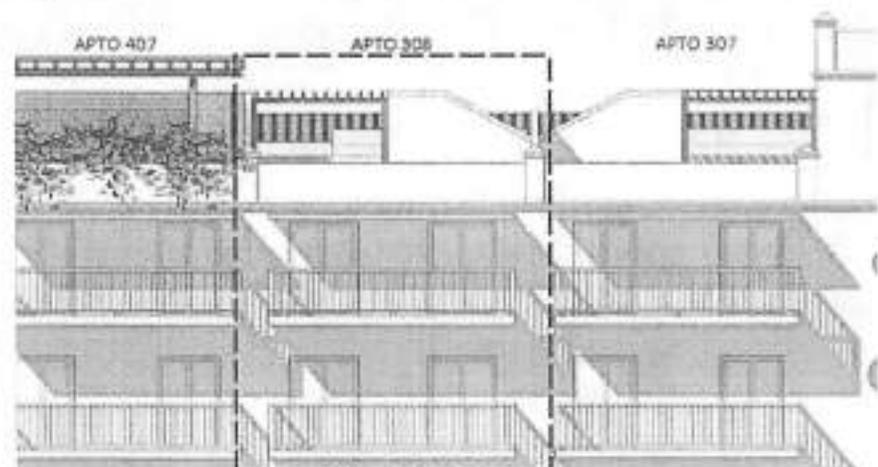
Planta Levantamiento cubierta plana (terrace) apto 308 donde se realiza zonificación de espacio.
